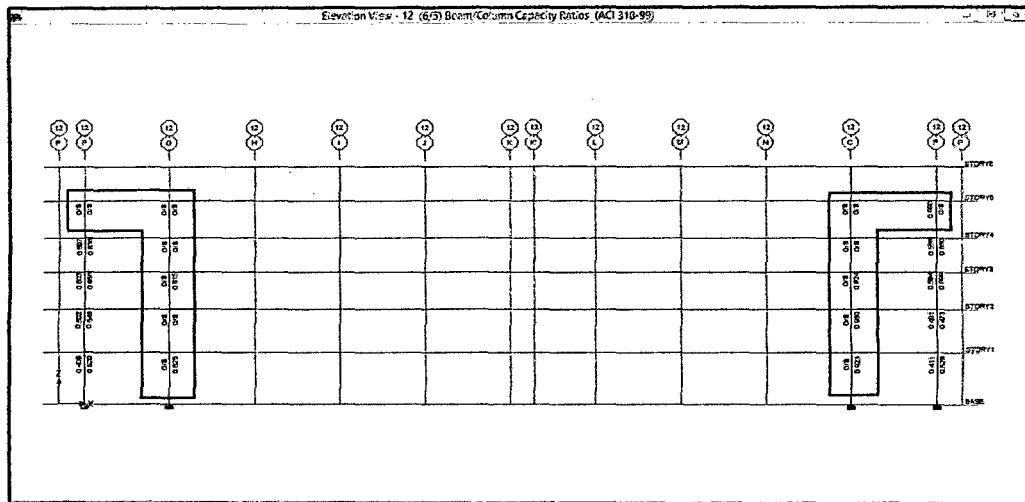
Ubicación de Fallas en columnas – Eje 12
